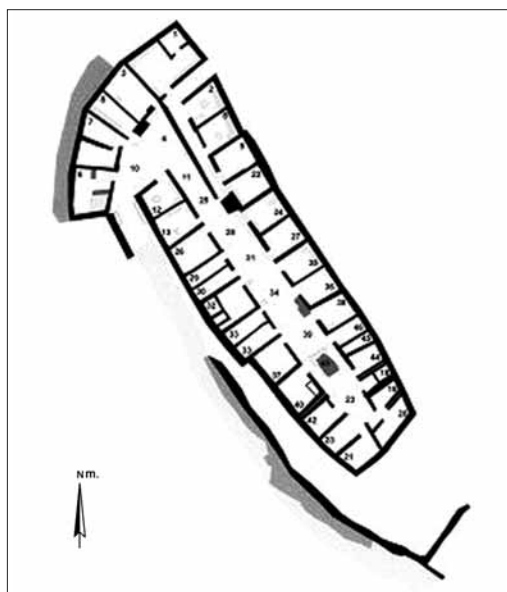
Planimetría del Castellet de Bernabé (cedida por Dr.D. Pierre Guérin).
